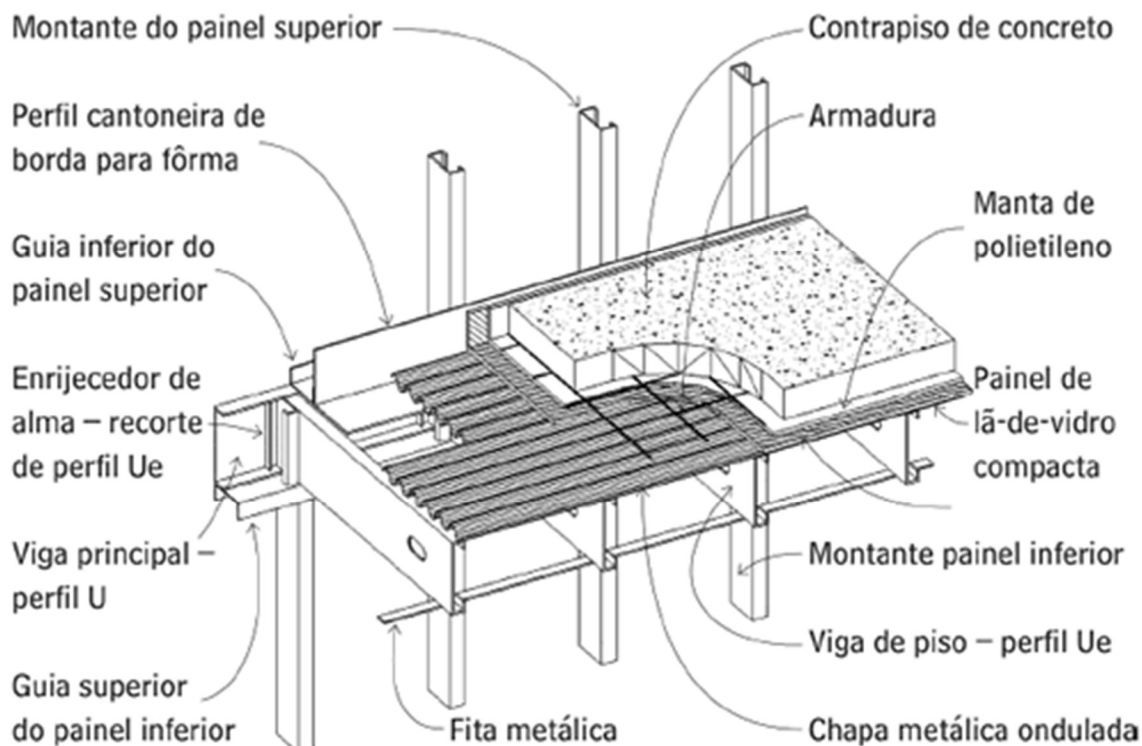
Esquema estrutural da laje úmida em *LSF
